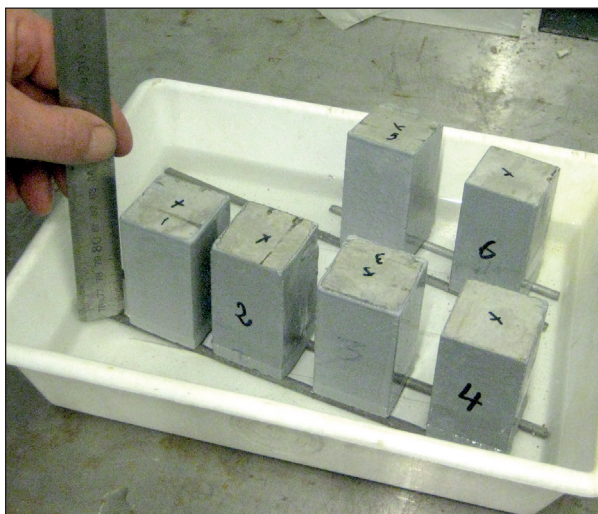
Essai d'absorption d'eau sur les mortiers de jointoiment liés au ciment selon la NBN EN 12808-5
